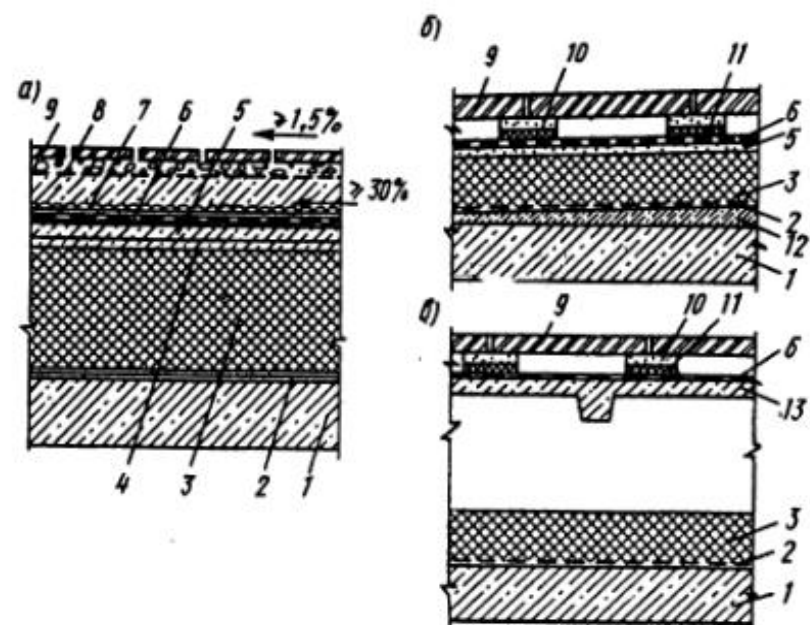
Конструкции эксплуатируемых крыш: а – бесчердачная с дренажным слоем; б – то же без дренажа; в – над холодным чердаком или раздельной бесчердачной крышей; 1 – несущая плита покрытия (чердачного перекрытия); 2 – пароизоляционный слой; 3 – утеплитель; 4 – выравнивающая стяжка; 5 – грунтовка битумной эмульсией; 6 – рулонный гидроизоляционный ковер; 7 – мастика, пропитанная гербицидами; 8 – дренажный слой; 9 – каменные (бетонные) плиты пола; 10 – бетонная прокладка; 11 – асфальтовый маяк; 12 – легкий бетон или отсыпка по уклону; 13 – кровельная железобетонная плита
